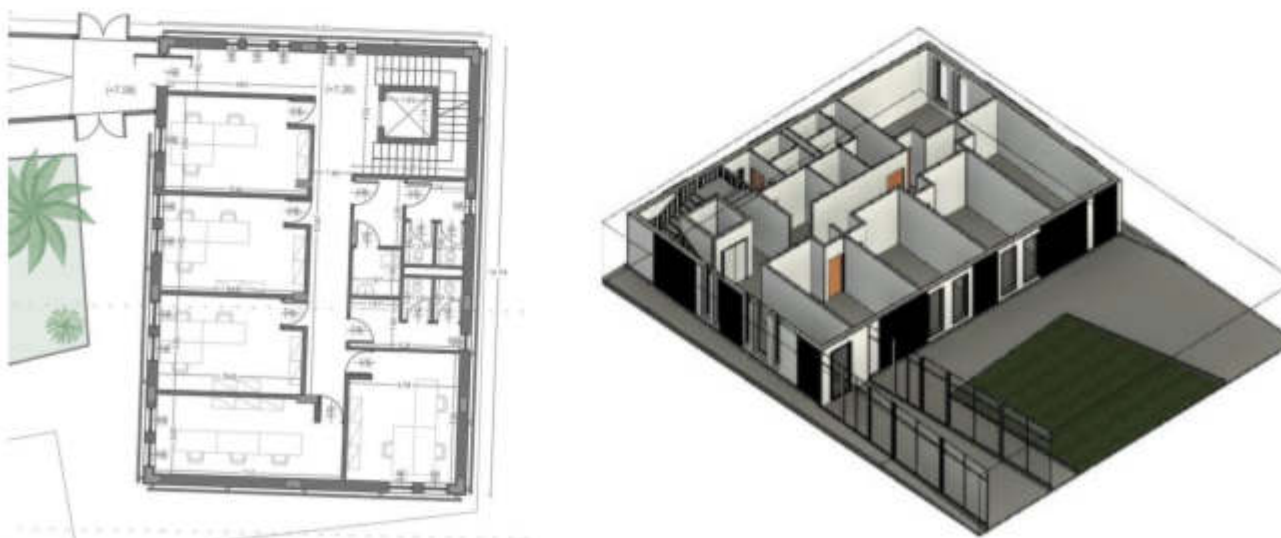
Stato di Progetto - Corpo A - Pianta e Spaccato Assonometrico Pianta Livello II
